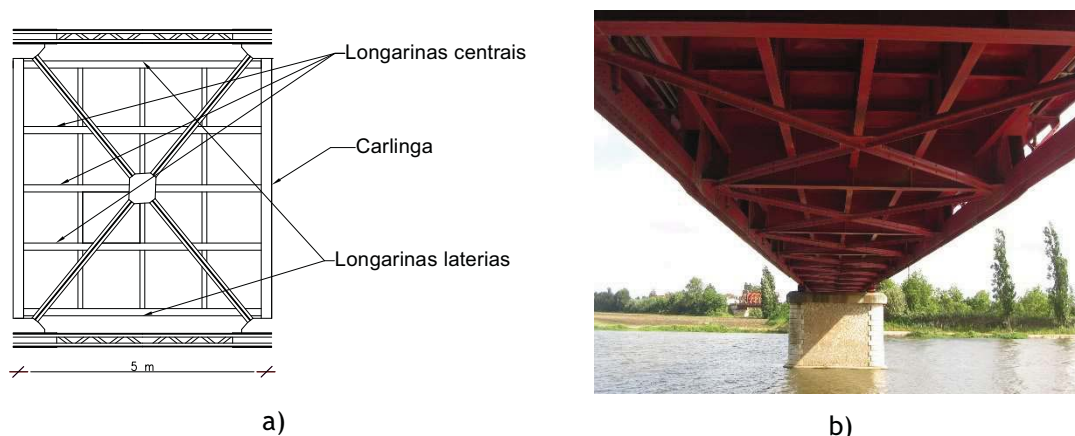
a) Desenho pormenor de um dos módulos da grelha metálica. b) Fotografia da grelha metálica da ponte
